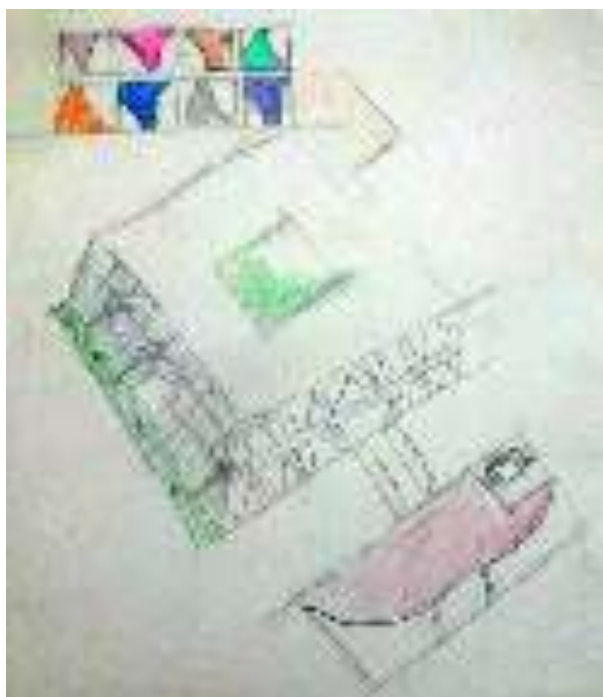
Estudos de Massa e Fachada. Autora, 2014.
